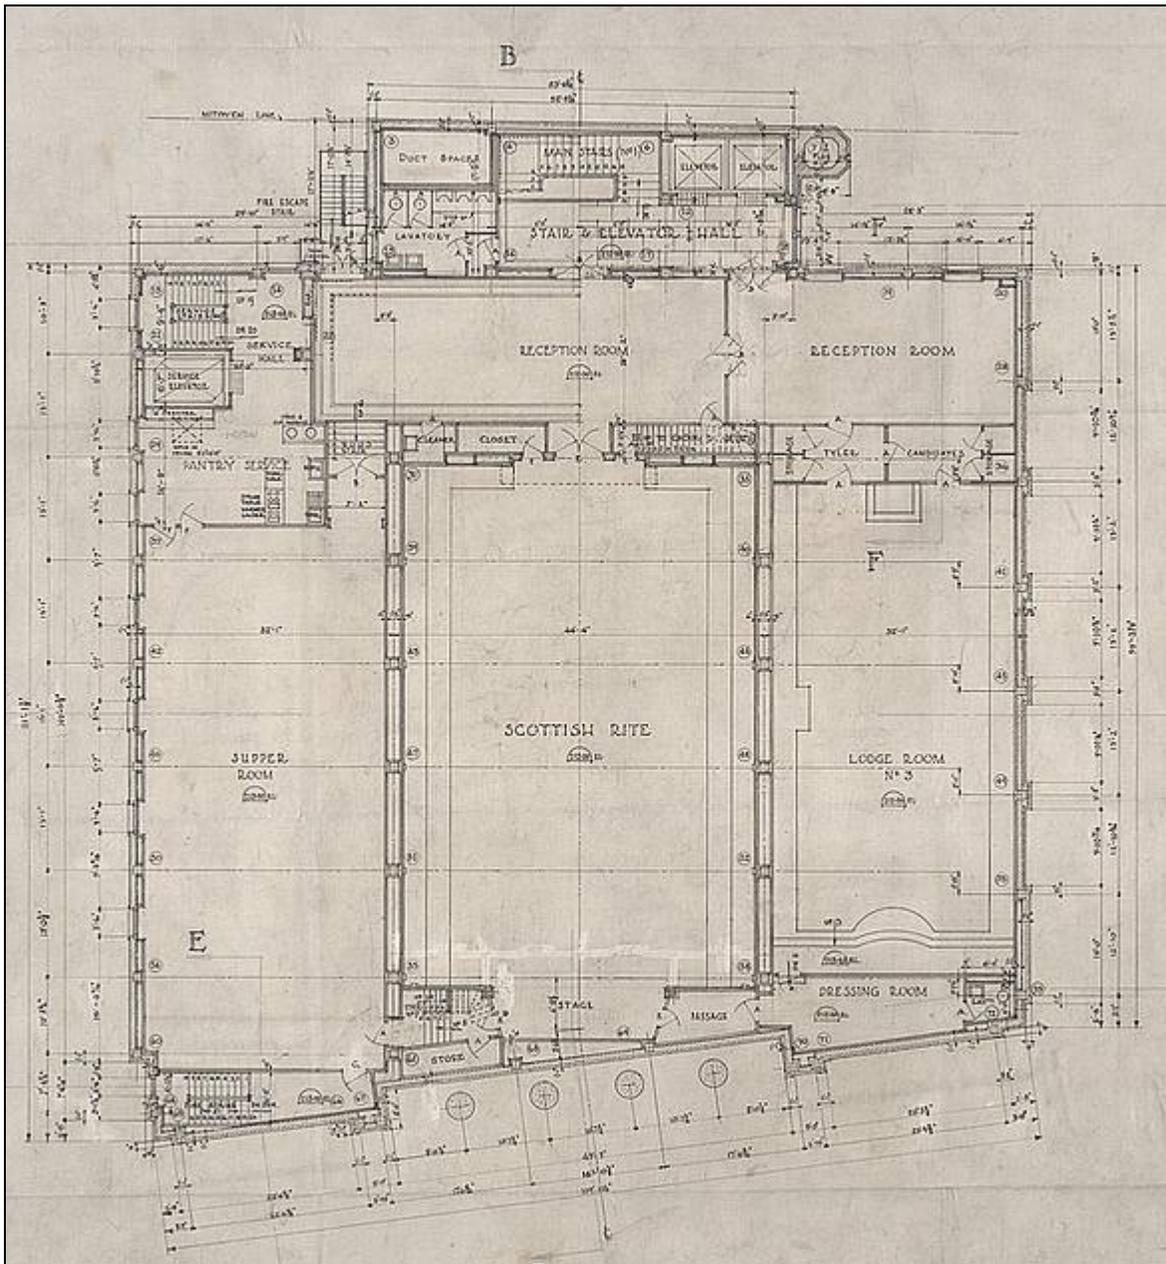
Plan du *second floor*, ou étage n° 7 (détail de la feuille du plan).
